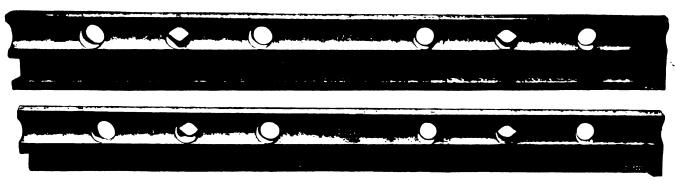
Endplatten-Querschnitt A und B mit Schlußstück.
